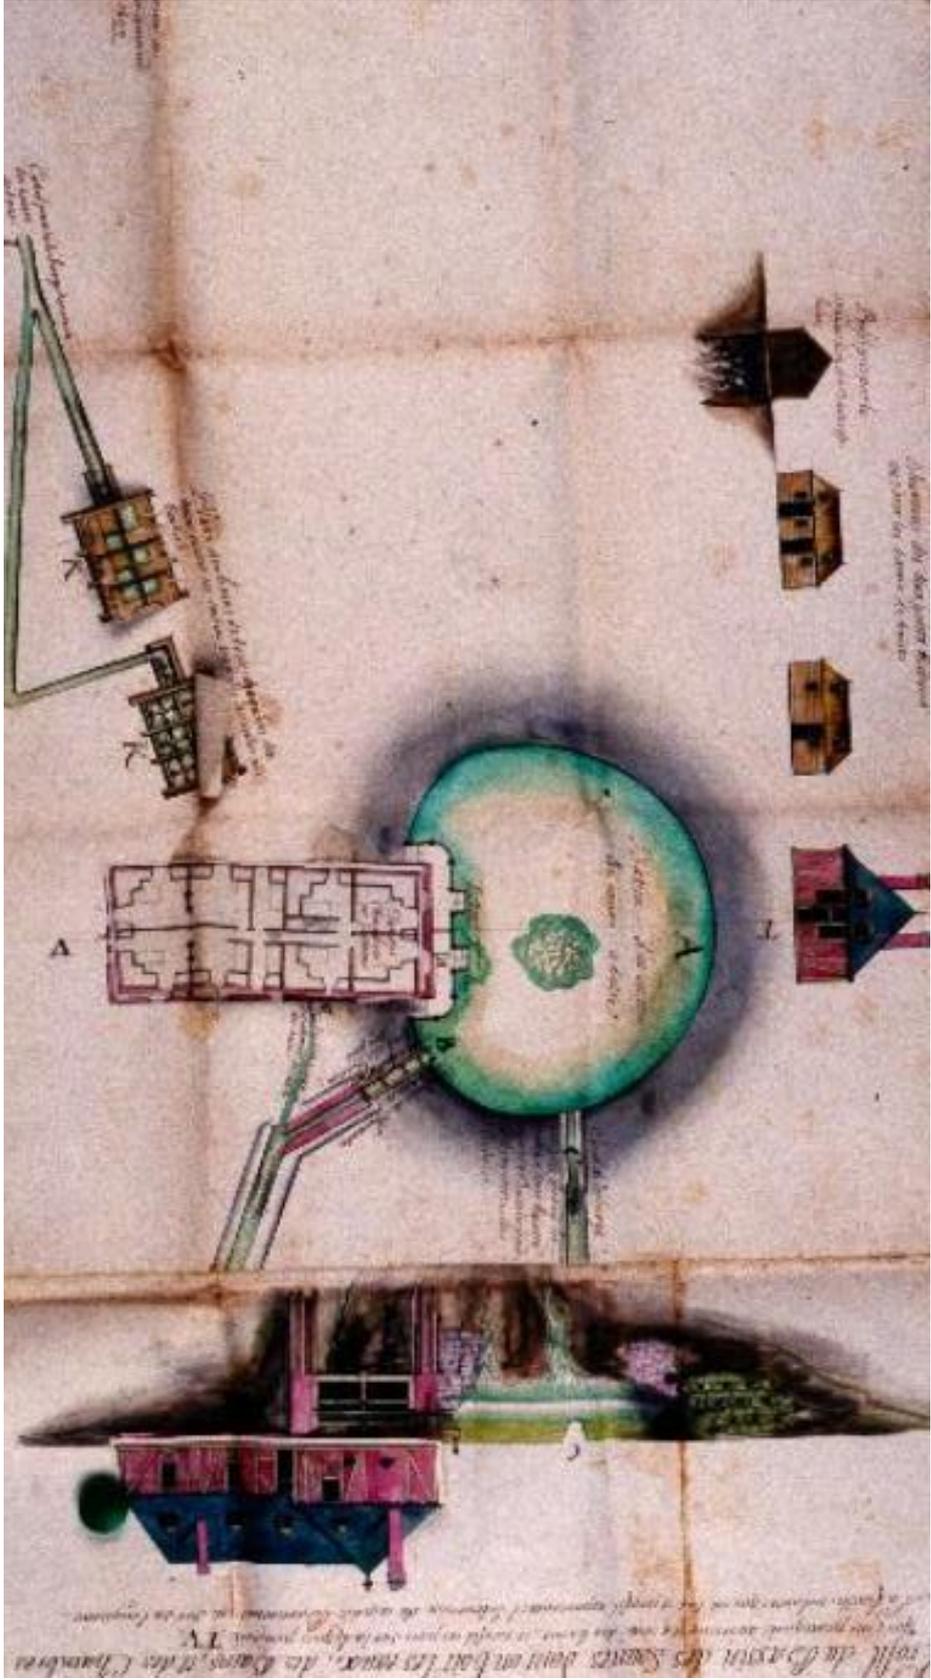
Plan et coupe du bassin recueillant les eaux [Grand Bouillon ?] de Saint-Amand avec plan, coupe et élévations de l'établissement thermal par Mesgrigny, 1699 (S.H.D. Vincennes. Saint-Amand-les-Eaux : GR 1 VH 2241, © Région Hauts-de-France, Inventaire général du patrimoine.
